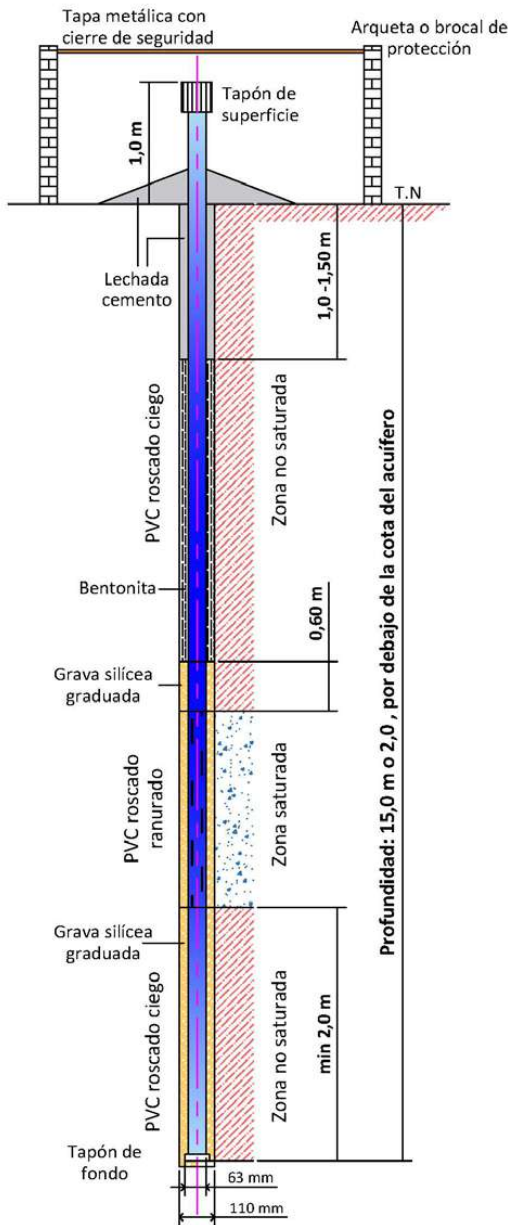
Croquis constructivo propuesto para los piezómetros de control
